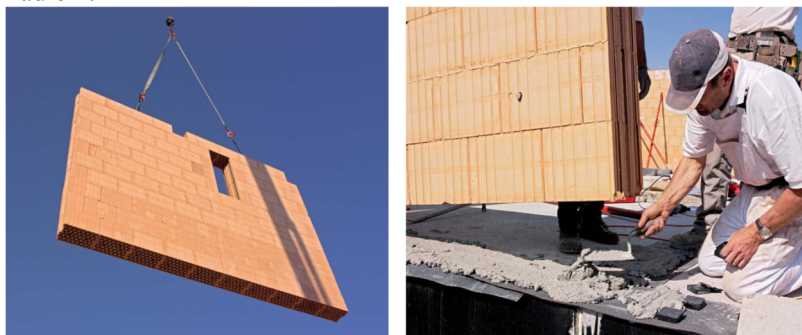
Sistema construtivo Redbloc. Fonte: Redbloc Systems (S.D.).
